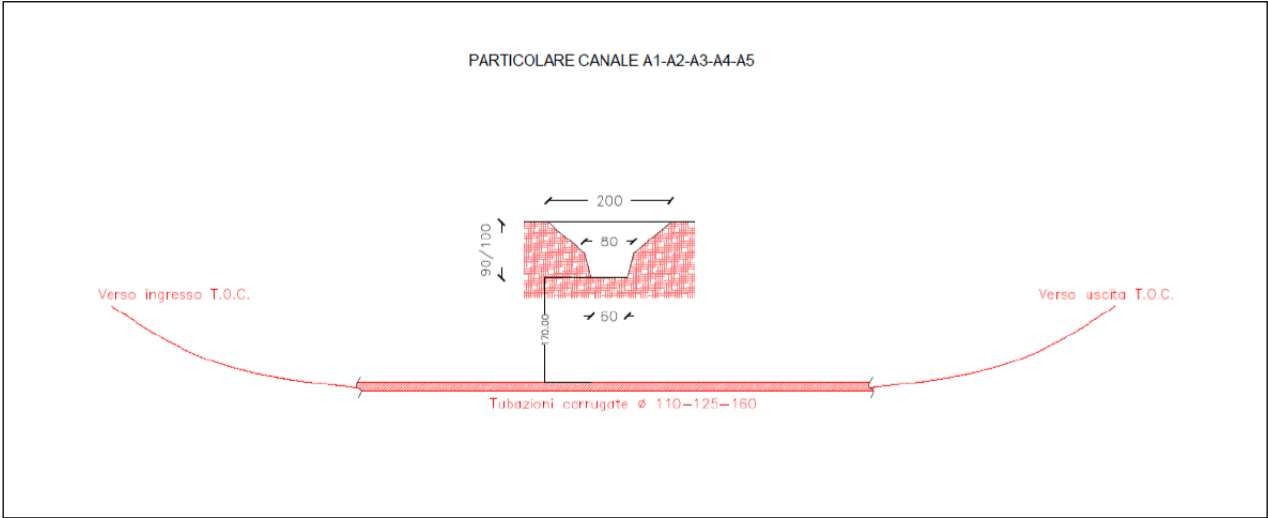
Dettaglio attraversamento in T.O.C. canale tipo A1-A2-A3-A4-A5
